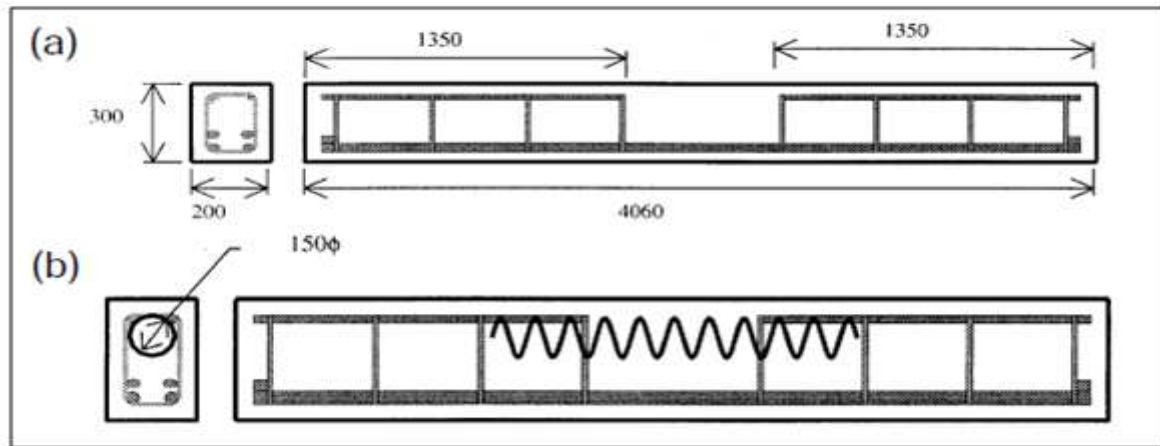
dimensions de la poutre, (a) poutre universelle; et (B) poutres hélicoïdalement renforcées.
